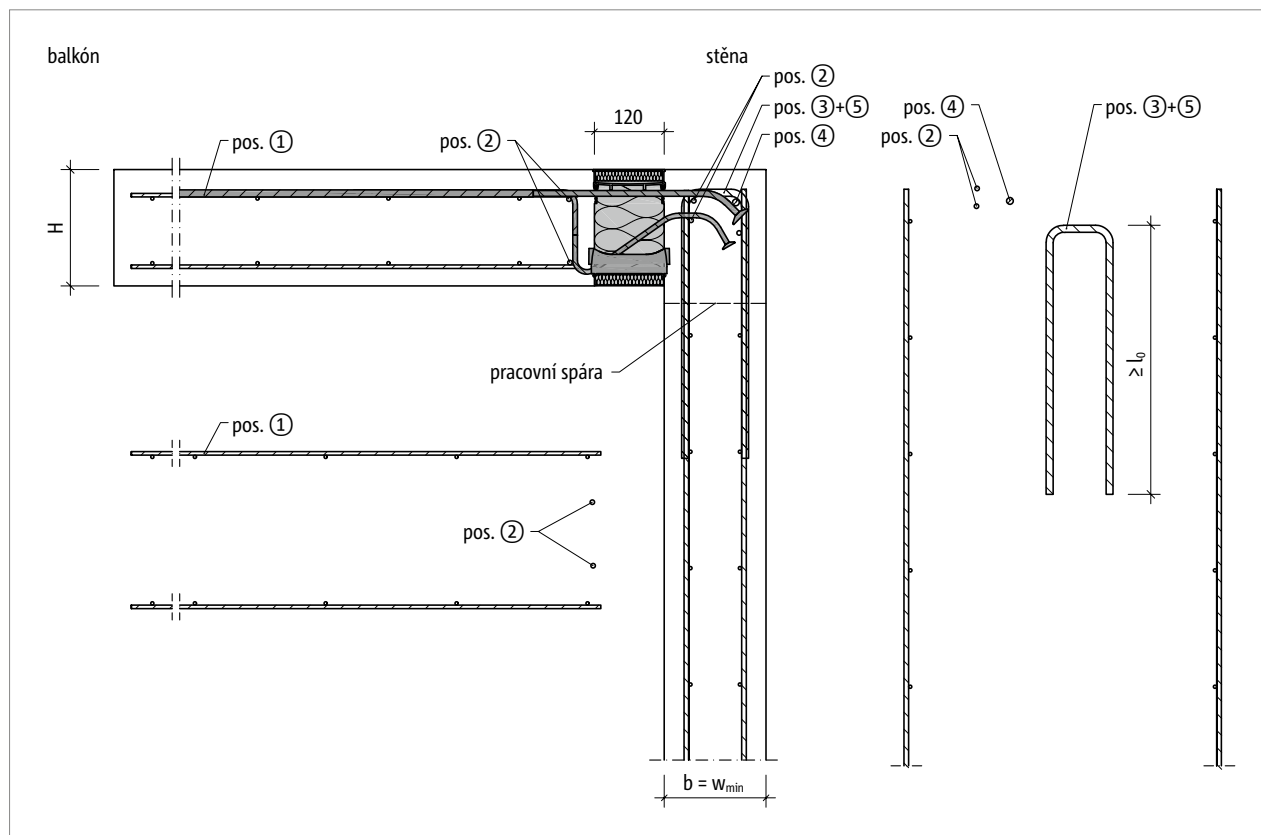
Schöck Isokorb® XT typ KL-O: Napojovací stavební výztuž pro balkón nadvýšený oproti stropní desce – s větším rozměrem ($w_{skut} > w_{min}$)
